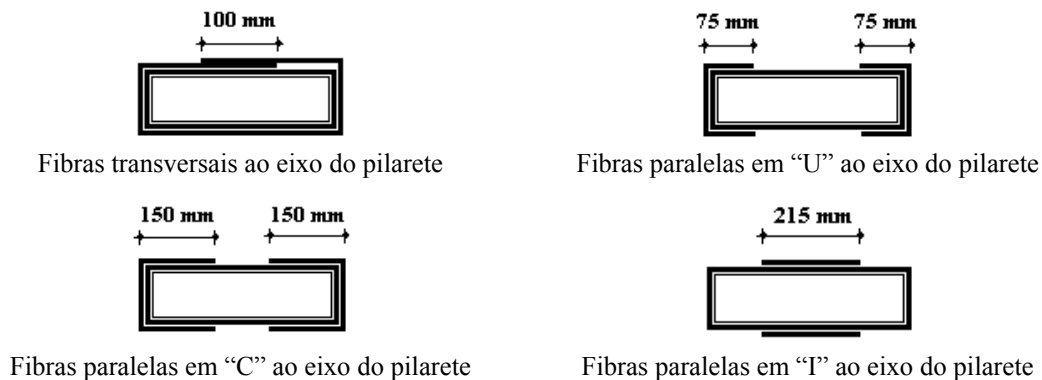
Espécimes de Concreto Armado de Seção Transversal Retangular Ensaaiados por TAN (2002)
